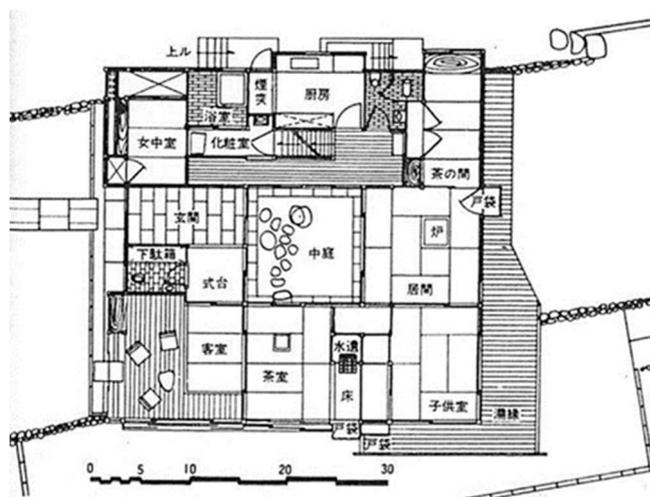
池辺陽設計「住宅 No. 0 (関西の家)」(1945) 1階平面図
